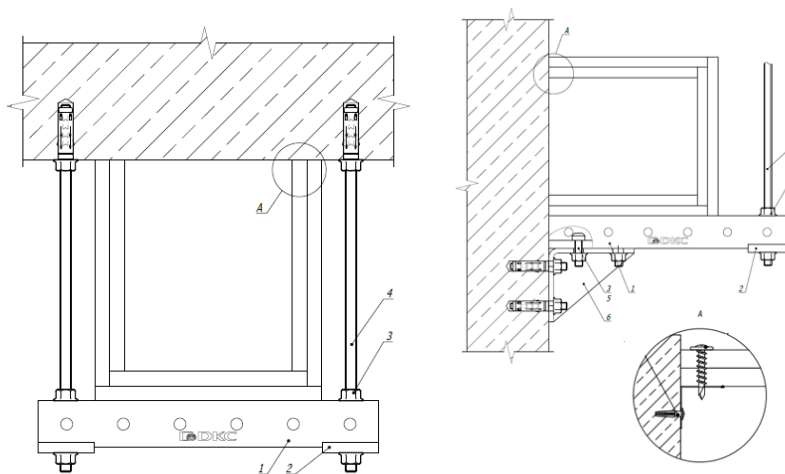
Крепление короба с тремя стенками к несущей поверхности
